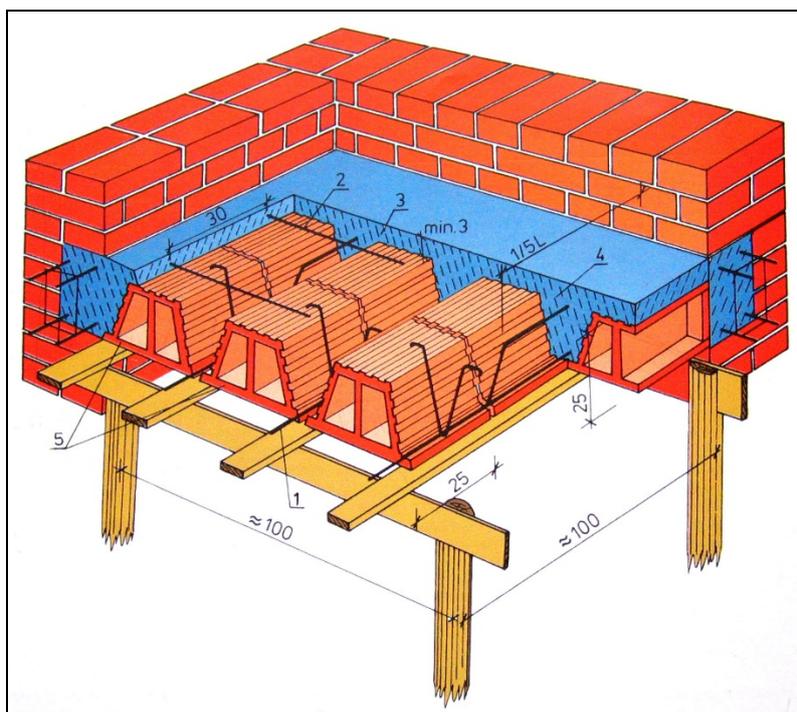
Сборно-монолитное балочное перекрытие, размеры даны в сантиметрах;
